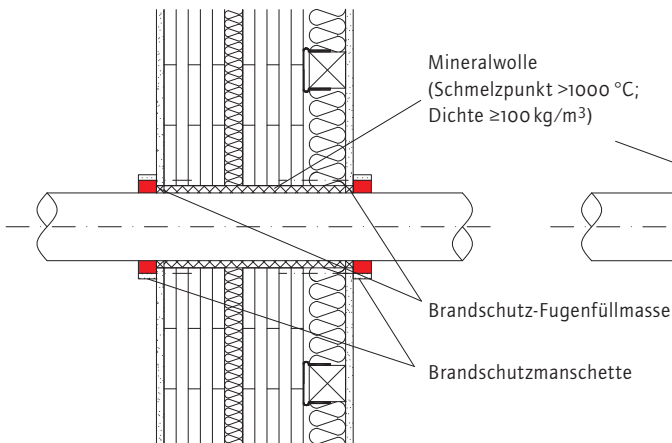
Durchführung eines Kunststoffrohres durch eine brandabschnittsbildende Wand mit einseitiger Installationsebene
